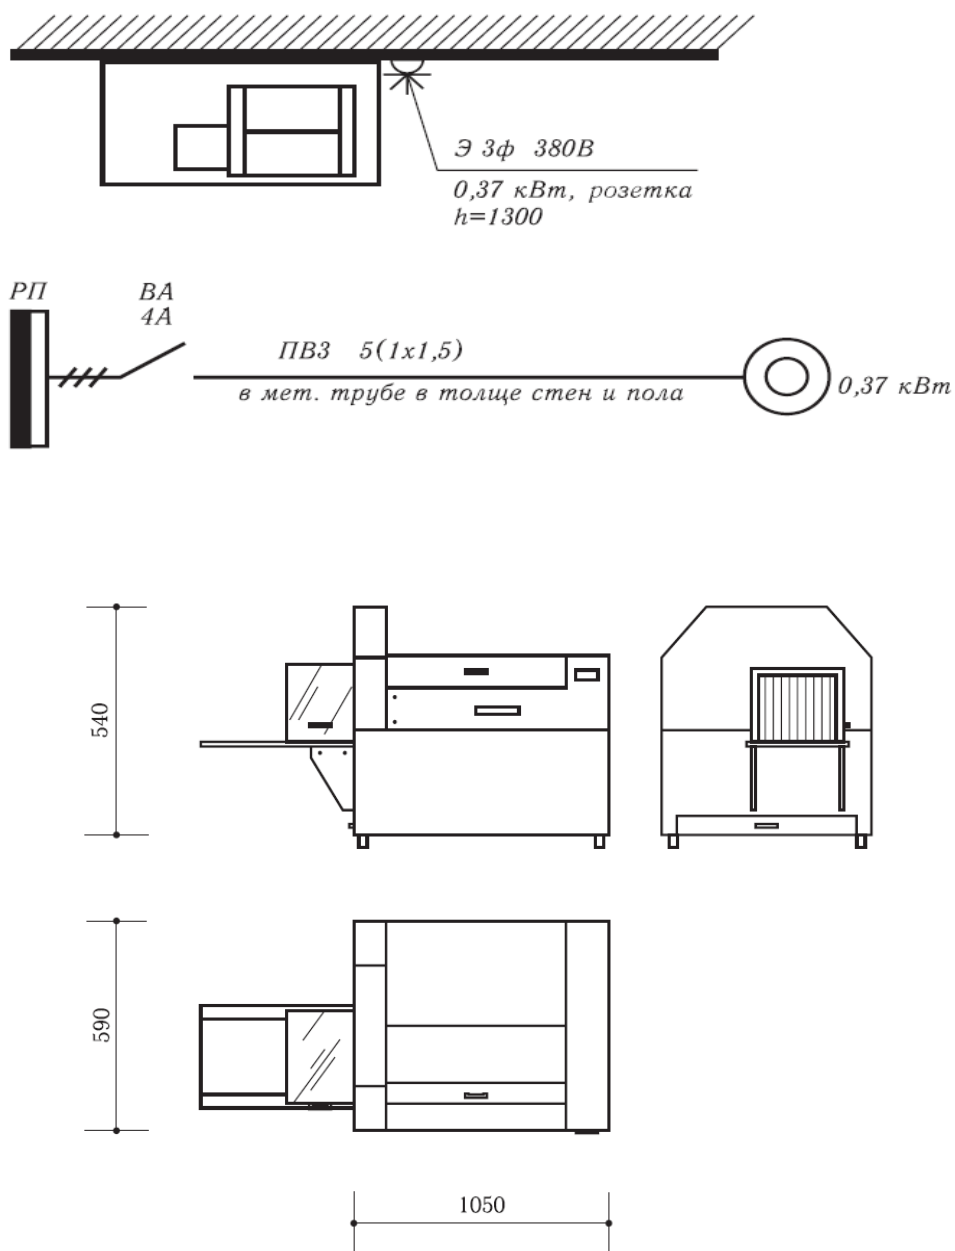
Схема подключения и габаритные размеры машины для нарезки хлеба АХМ-300
